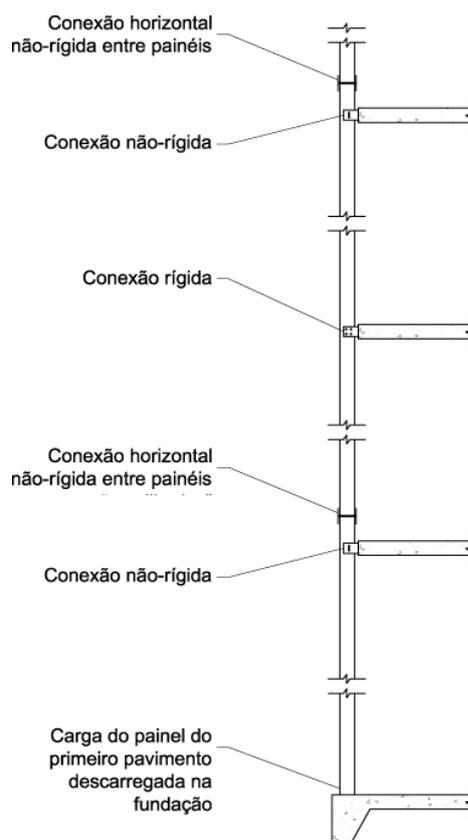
Painel dividido verticalmente, utilizando conexões rígidas e não-rígidas alternadamente
